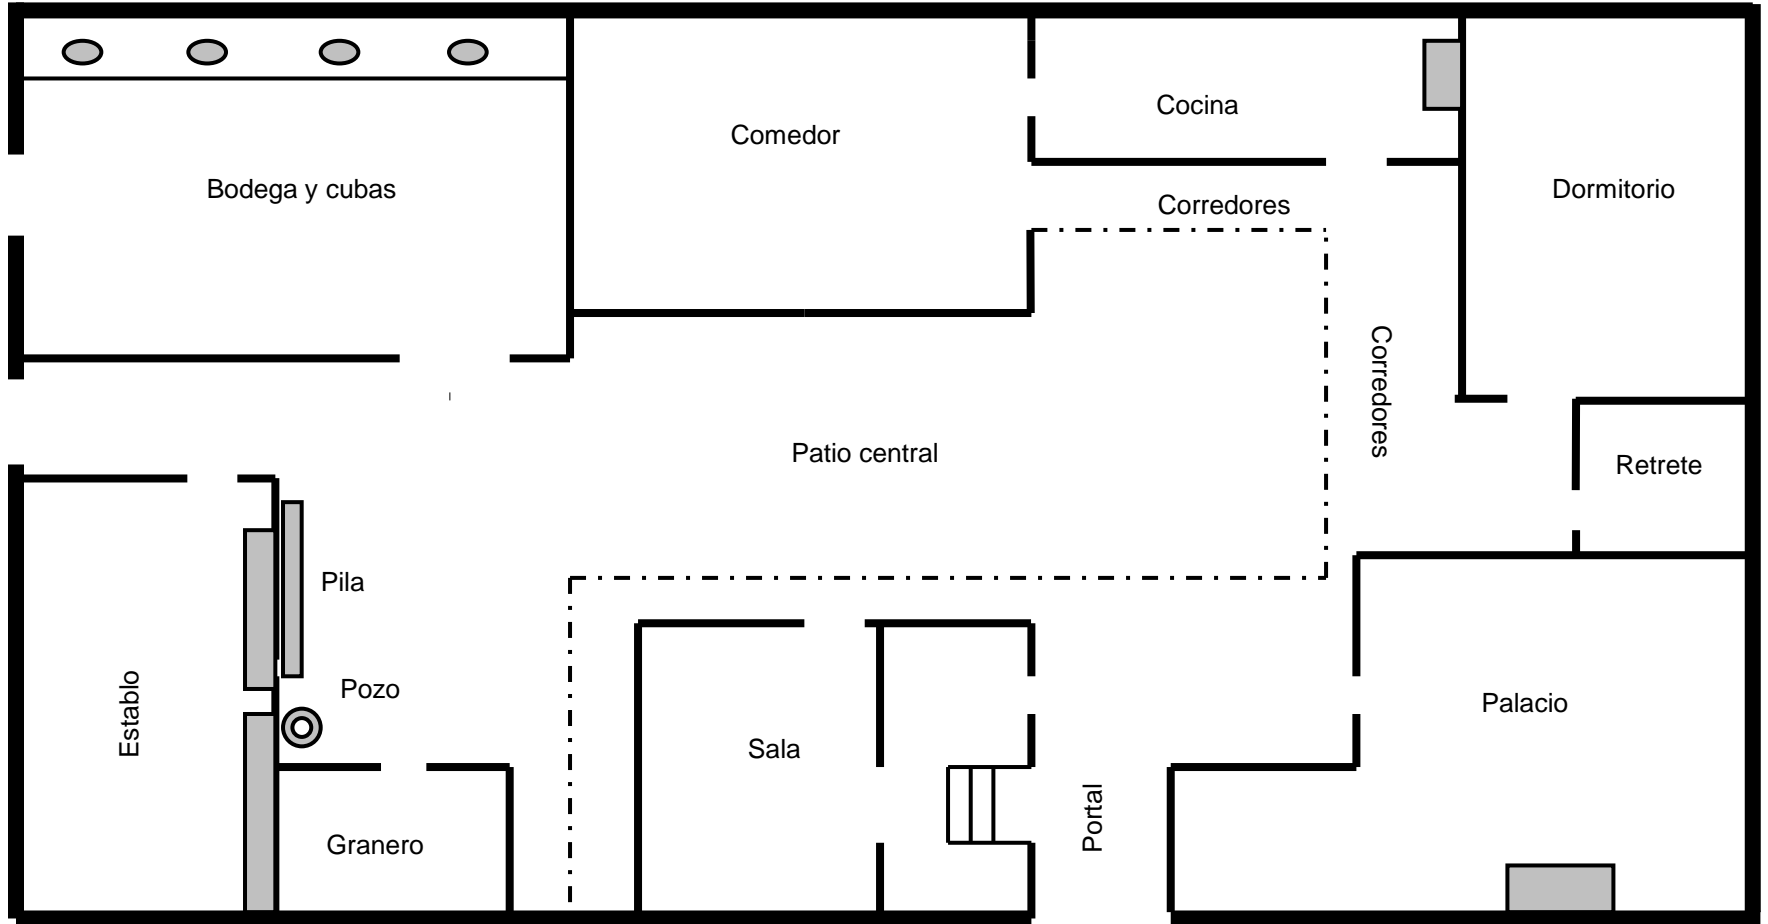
Recreación plano casa de dos plantas de dimensiones grandes
